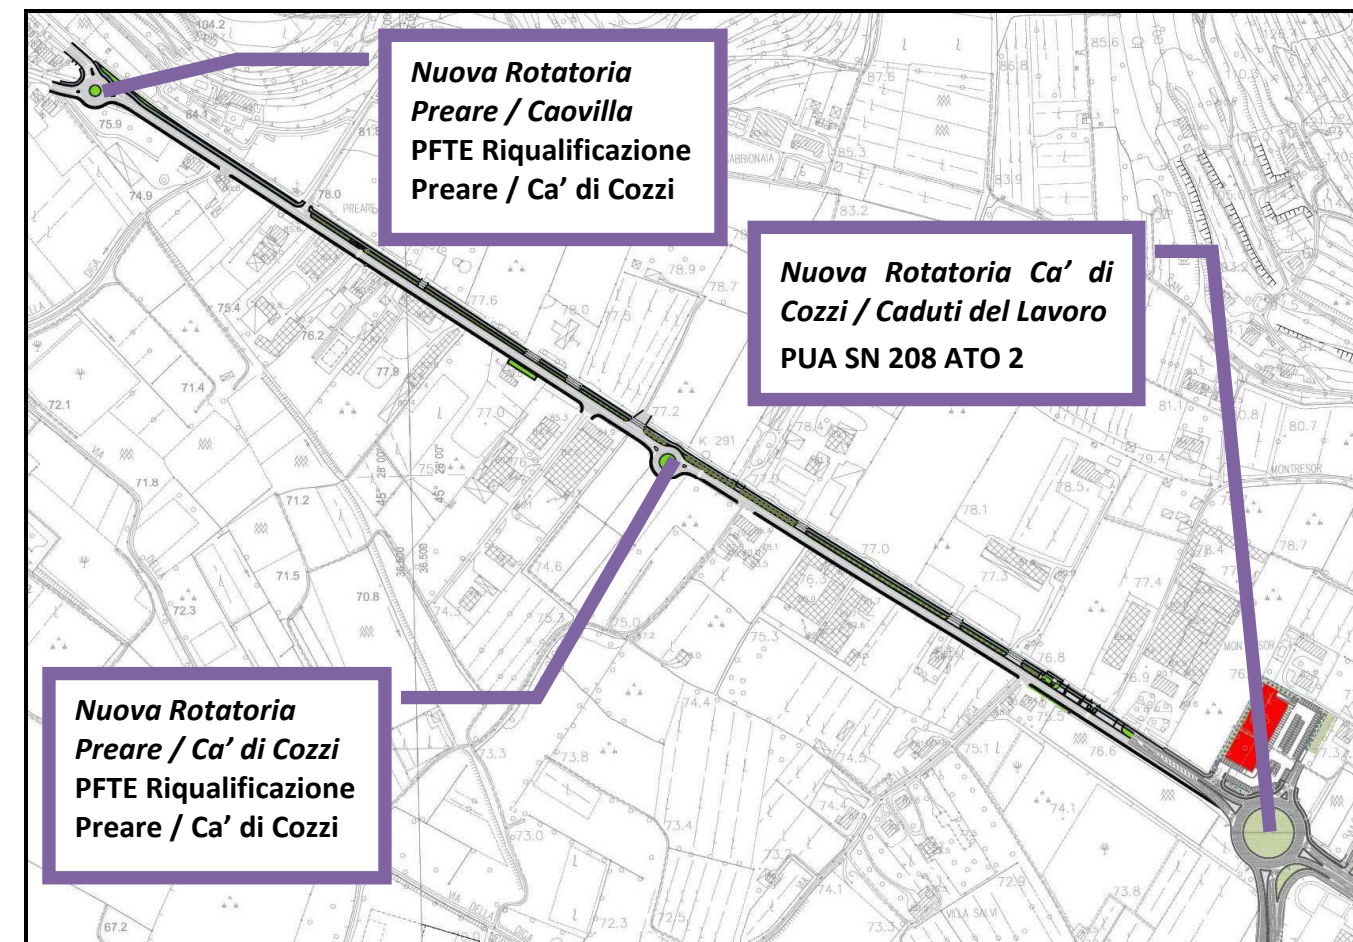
Planimetria PFTE Preare / Ca' di Cozzi
